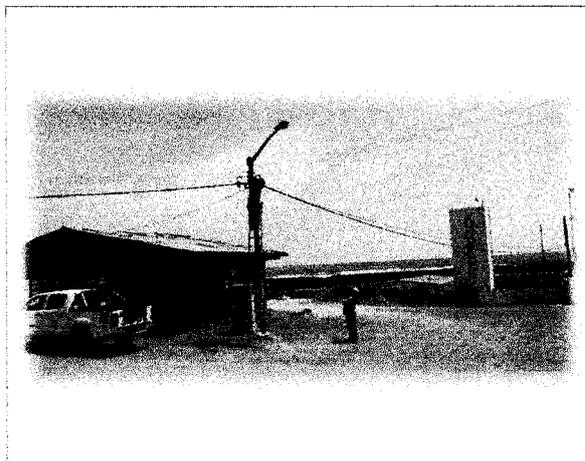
INSTALACIÓN DE MEDIDOR ELÉCTRICO PARA LA OBRA.
